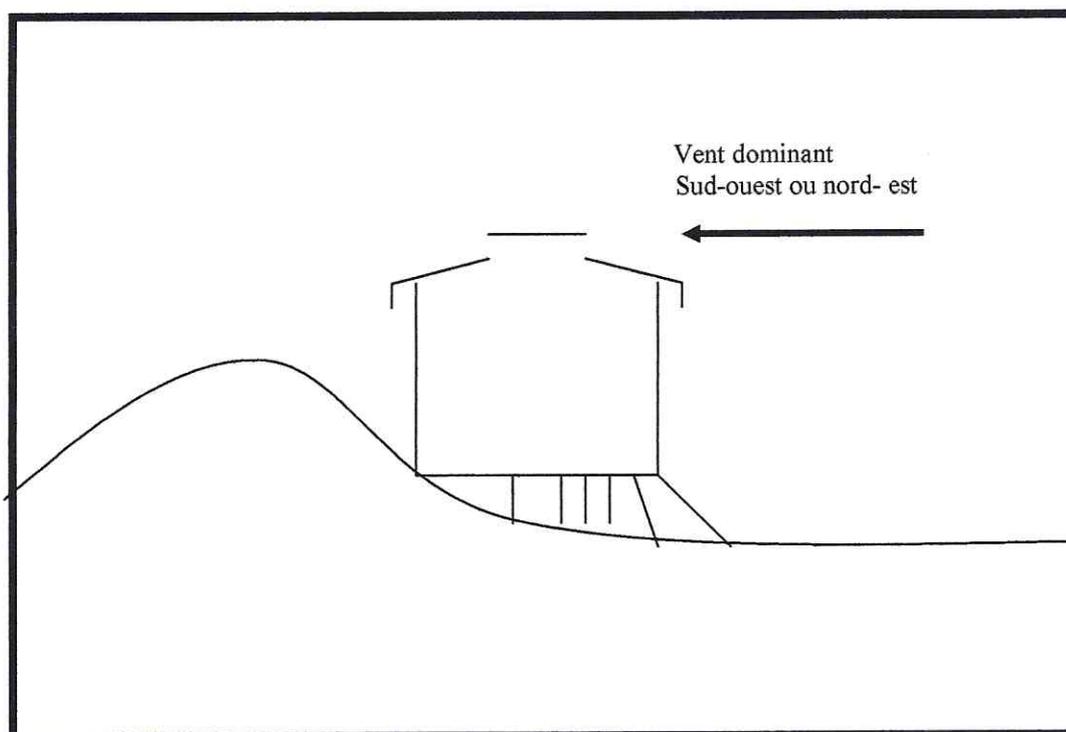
Implantation d'un bâtiment sur une colline (Rosset R., 1998).
